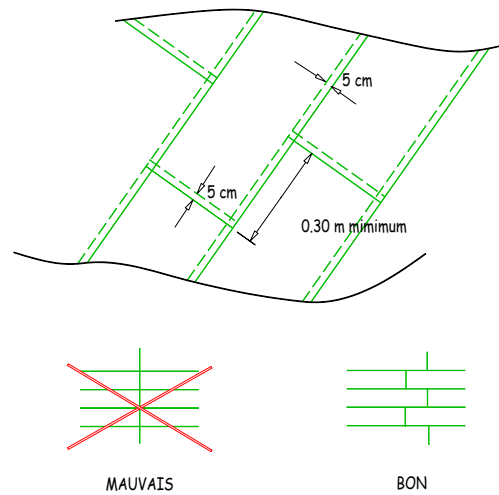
Dispositions relatives à la soudure des lès
